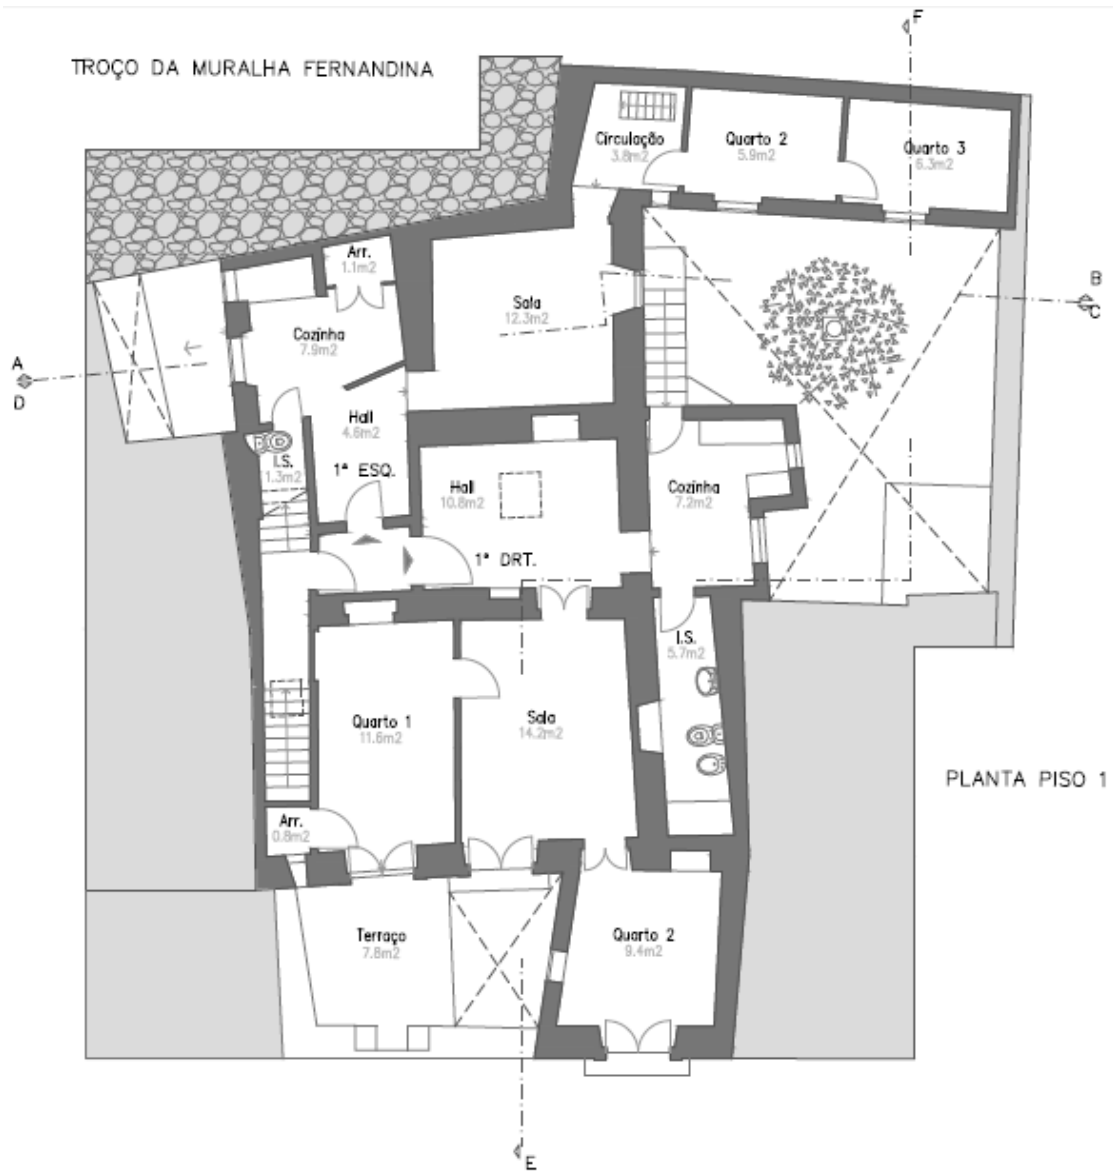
Planta Piso 01 existente (Sousa et al., 2021).
